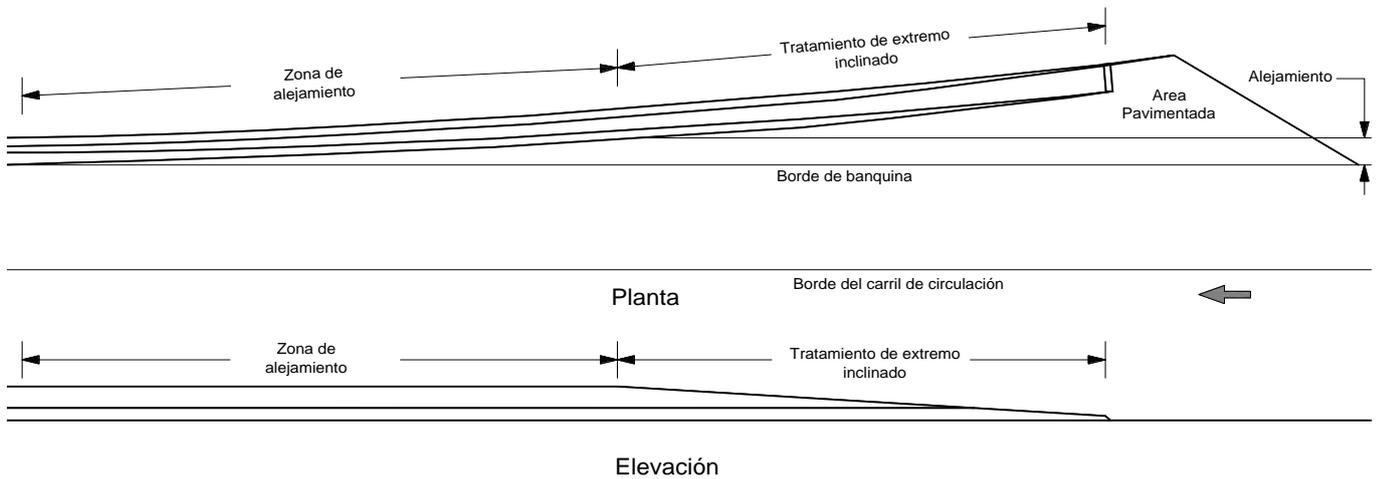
BARRERA DE VIGA DE CONCRETO CON TRATAMIENTO DE EXTREMO ENTERRADO E INCLINADO
